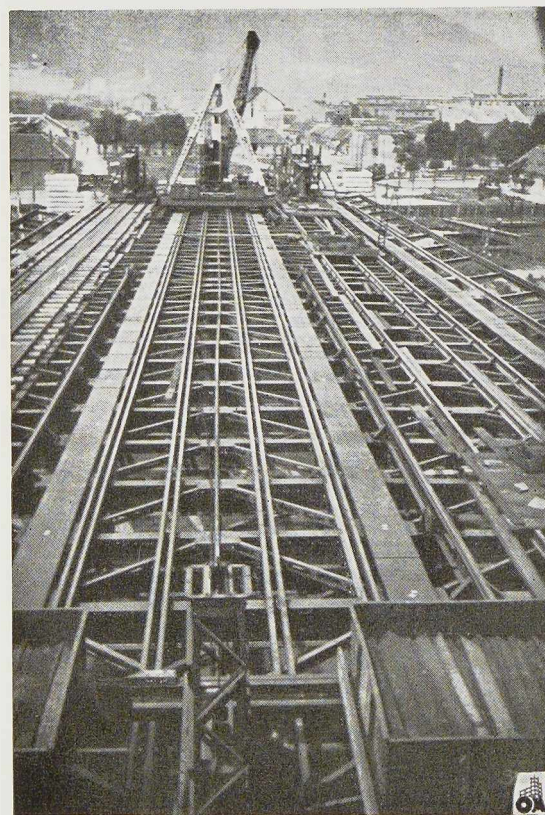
Contreventement supérieur et longeons du pont Arpád.
